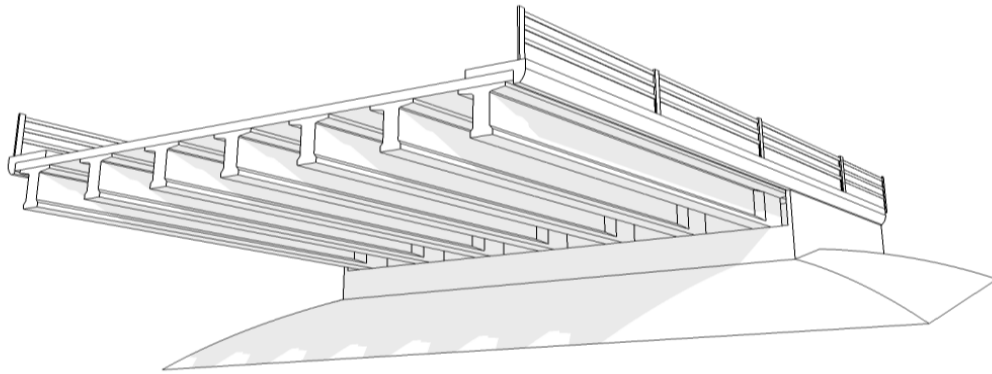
Morphologie générale d'un pont à poutres en béton précontraint.
